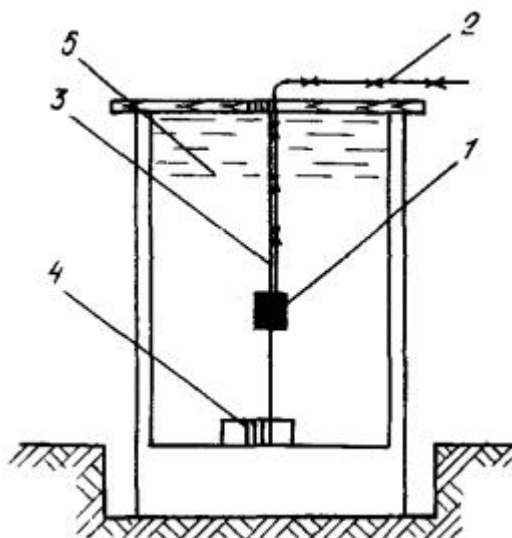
Размещение заряда при гидровзрывном способе разрушения емкостей:
